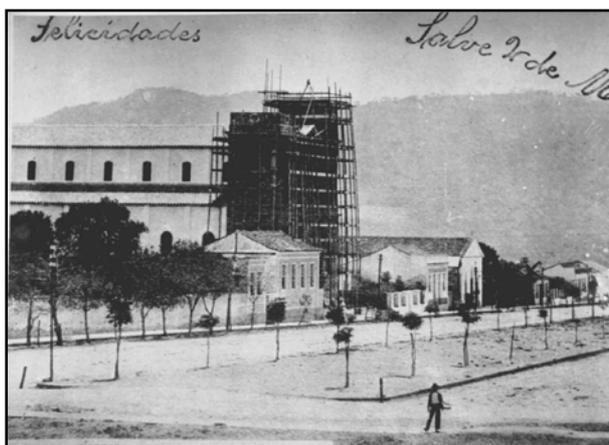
Face oeste da avenida Rio Branco. Ao centro, a Catedral Diocesana com sua fachada e torres em construção.
